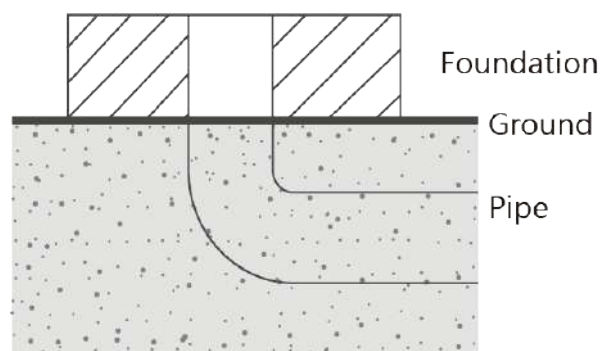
Membangun Fondasi Pengisi Alas
